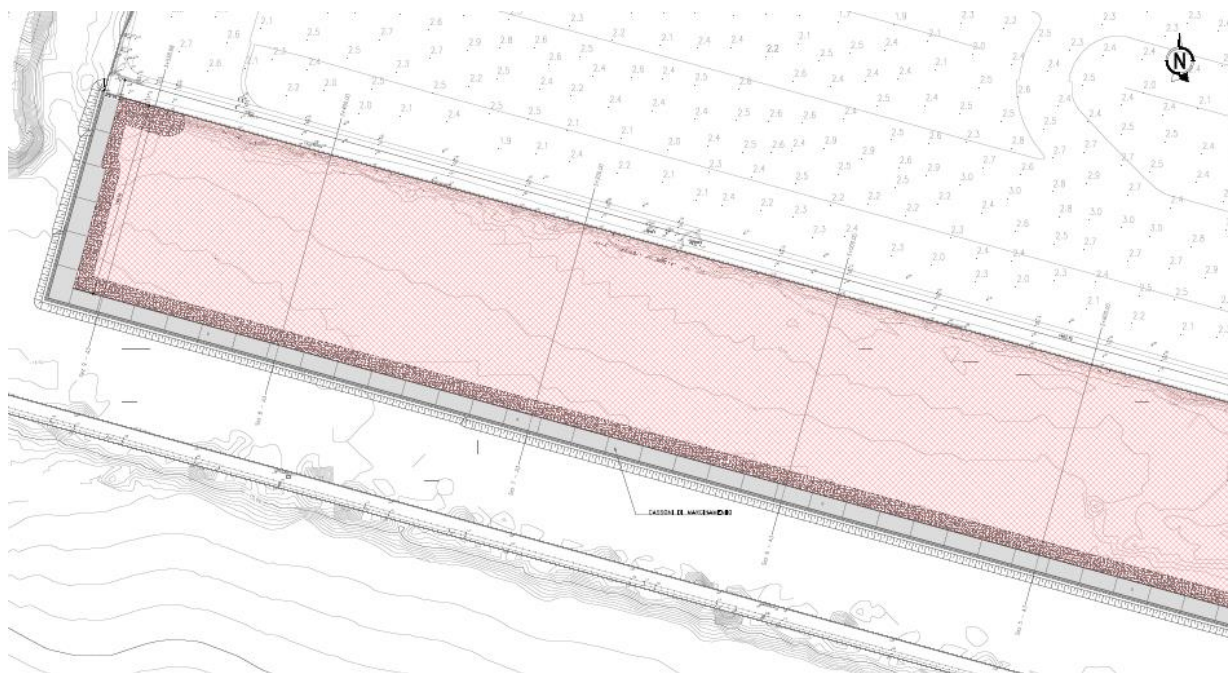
Vasca A3 Stralcio Planimetrico con individuazione dell'area interessata dalla posa in opera della geomembrana HDPE + geotessile tessuto non tessuto
